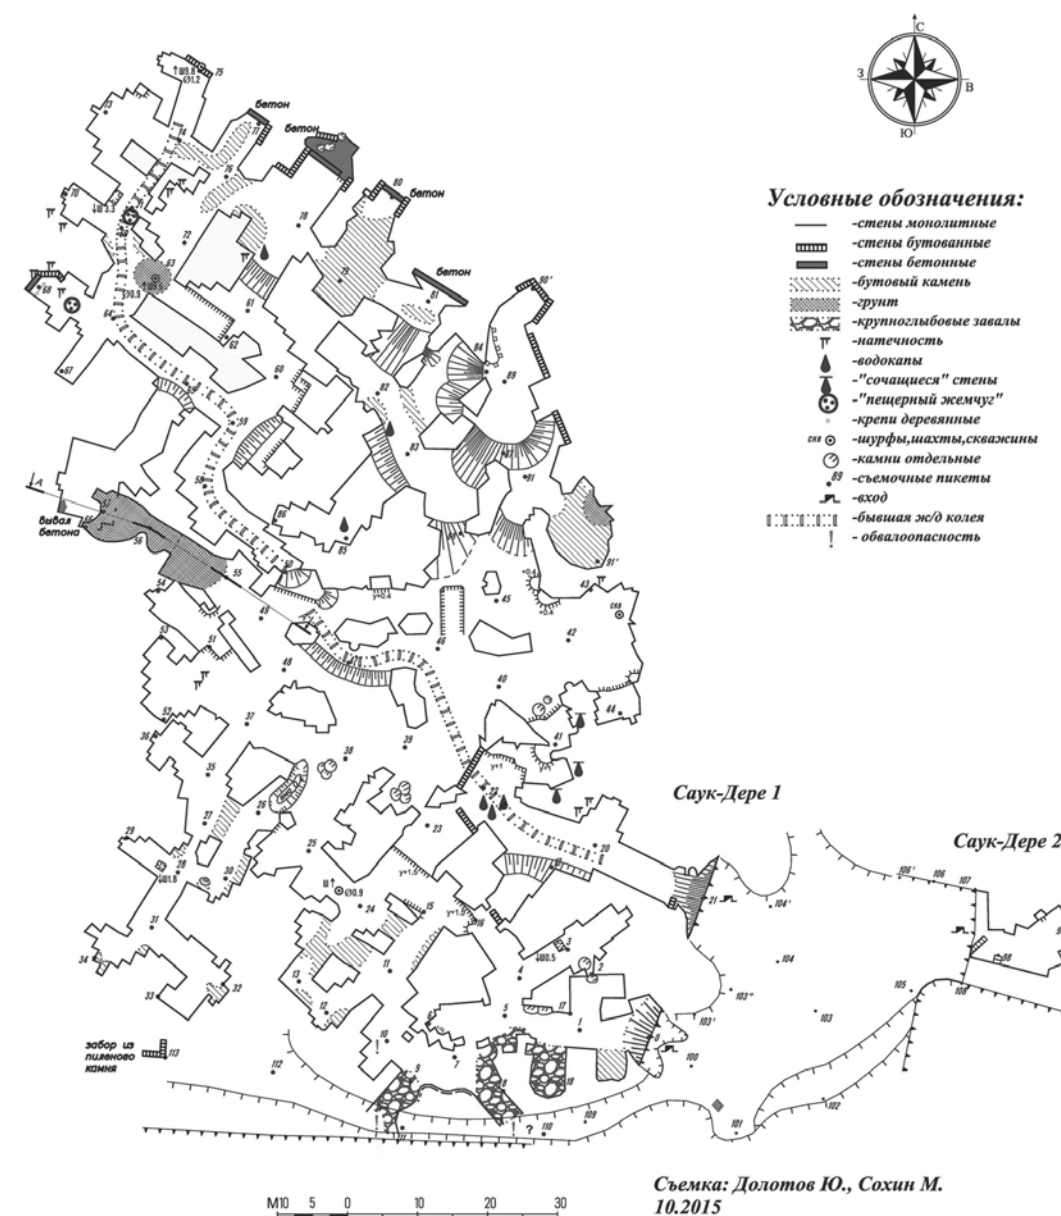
План подземных выработок Саук-Дере 1 и 2
